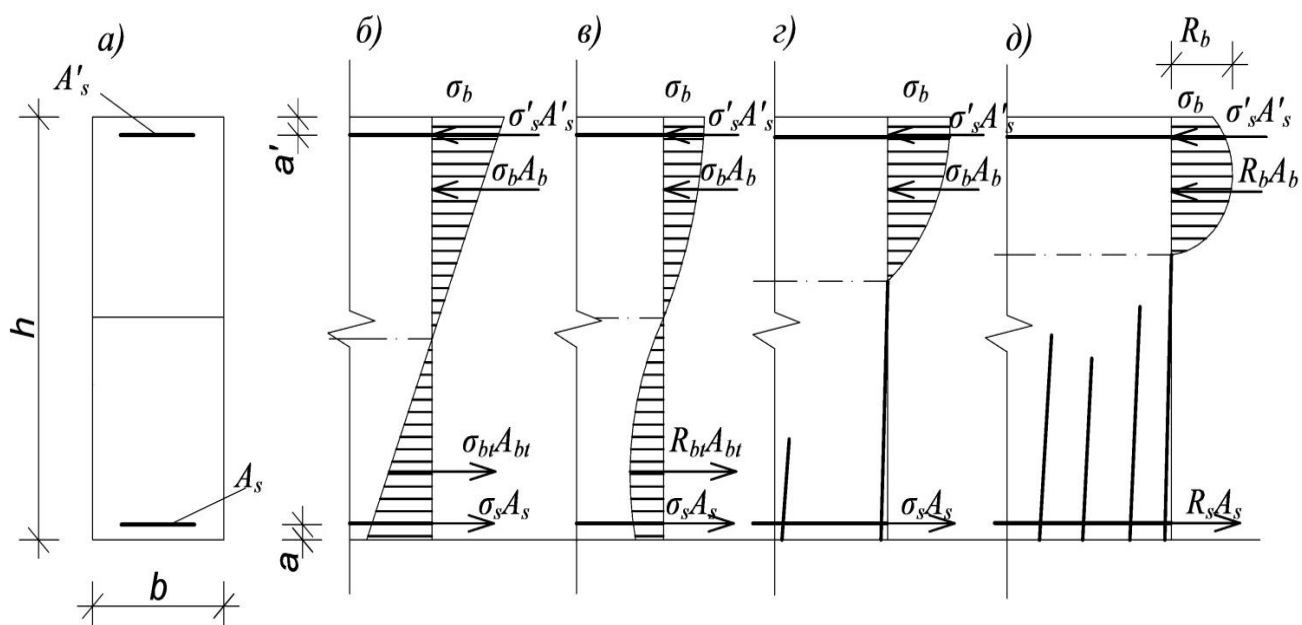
Этапы напряженно-деформированного состояния изгибаемых железобетонных элементов
